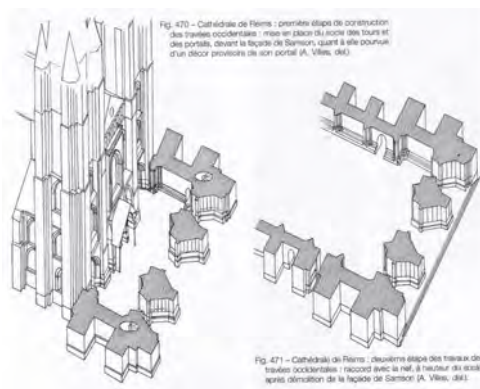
Reims : A. Villes : étape de construction de la façade.
